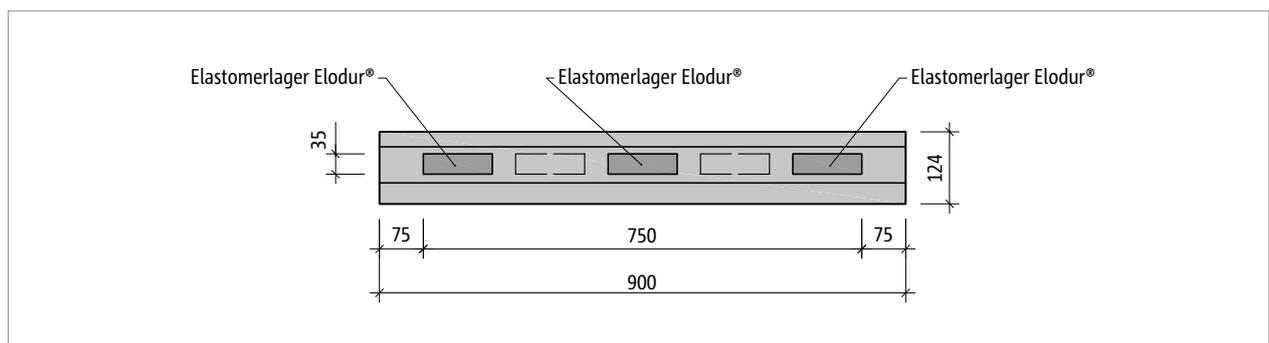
Schöck Tronsole® Typ F: Grundriss
